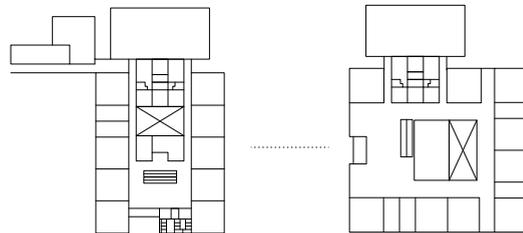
Grundrissentwicklung Bestand - Entwurf
